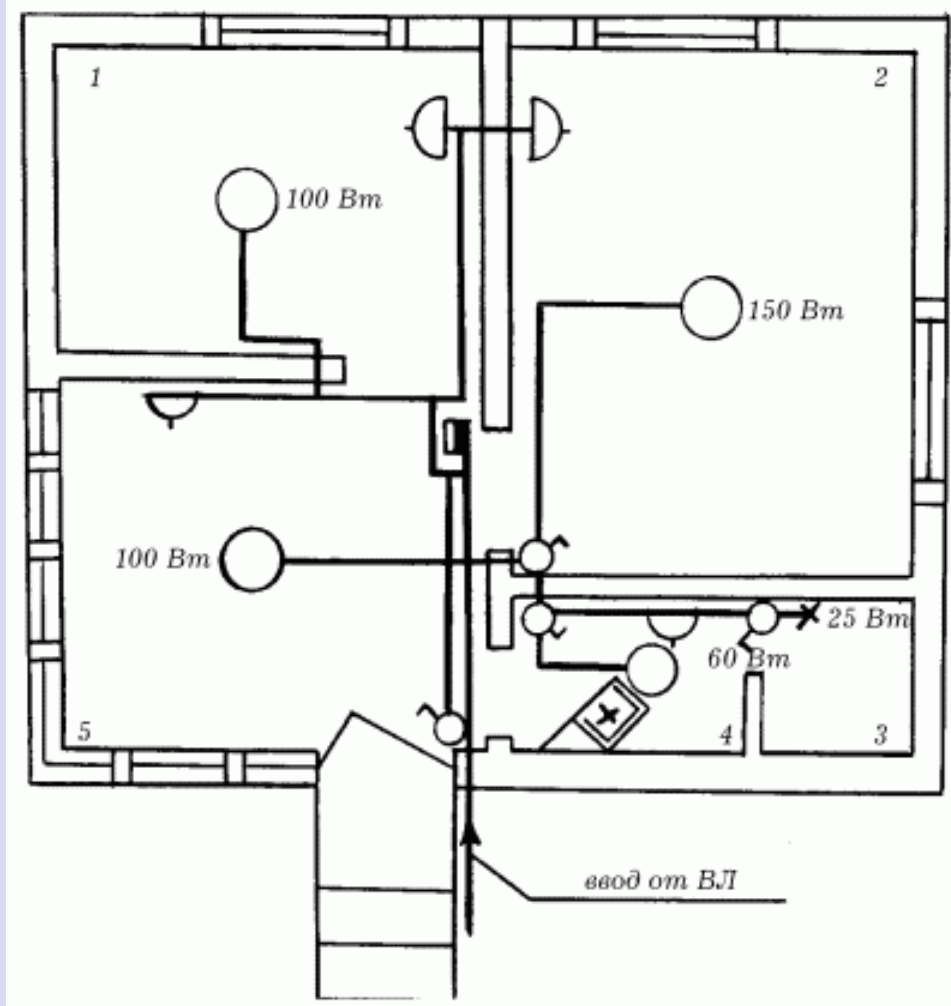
Схема электропроводки в двухкомнатном садовом доме (вид в плане): 1 – комната площадью 6,77 м²; 2 – комната площадью 11,3 м²; 3 – кладовая; 4 – кухня; 5 – терраса площадью 7,84 м².
